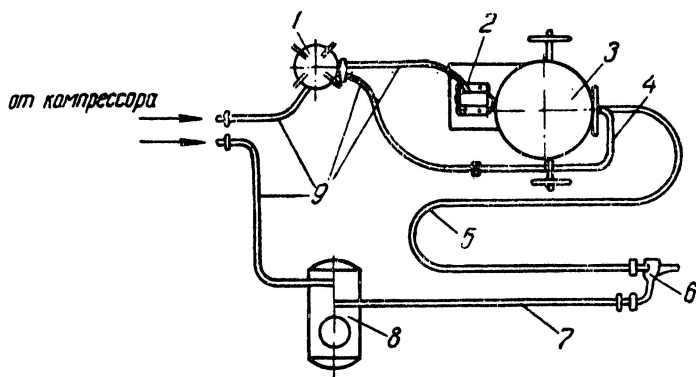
Схема торкретной установки: 1 — воздухоочиститель; 2 — воздушный мотор; 3 — цемент-пушка; 4 — металлический трубопровод цемент-пушки; 5 — материалый шланг; 6 — сопло; 7 — водяной шланг; 8 — водяной бак; 9 — воздушные шланги
